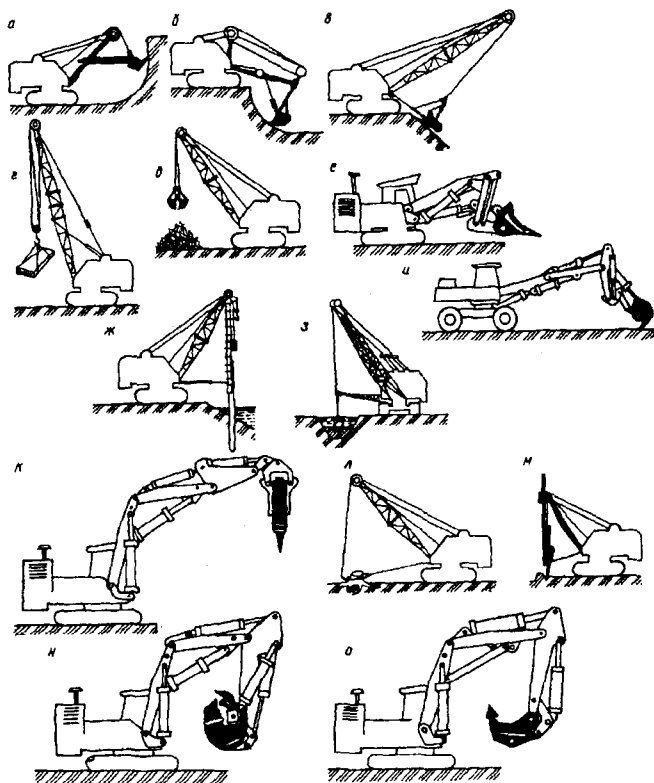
Схемы экскаваторов с различными видами рабочего оборудования: а — прямая лопата; б — обратная лопата; в — драглайн; г — кран; д — грейфер; е — погрузчик; ж — копер; з — боковой драглайн; и — планировщик; к — гидромолот; л — корчеватель; м — дизель-молот; н — захватно-лицевое оборудование с рыхлителем; о — рыхлитель.
